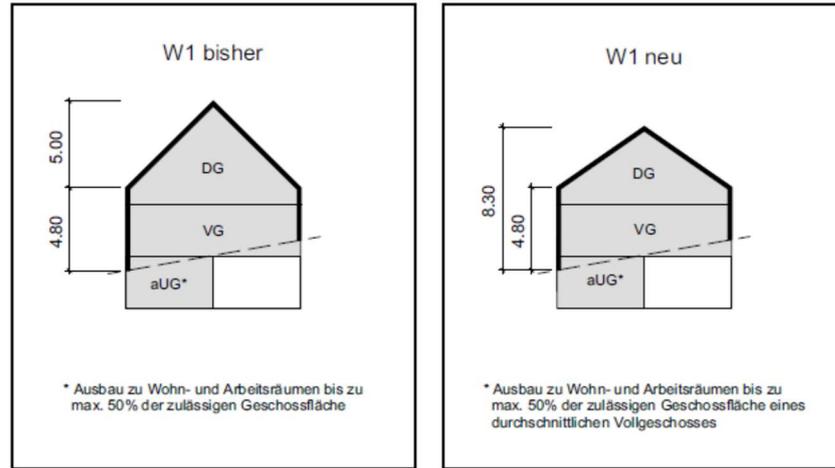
wesentliche Änderungen Art. 22 BZO Grundmasse W1/20
